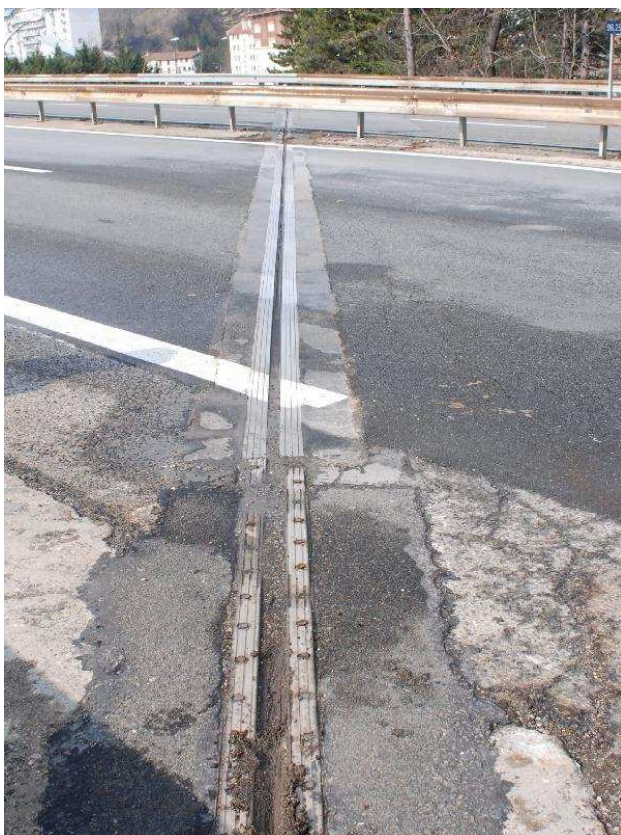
joint de chaussée NE - Photo 37 : Joint de chaussée NO
